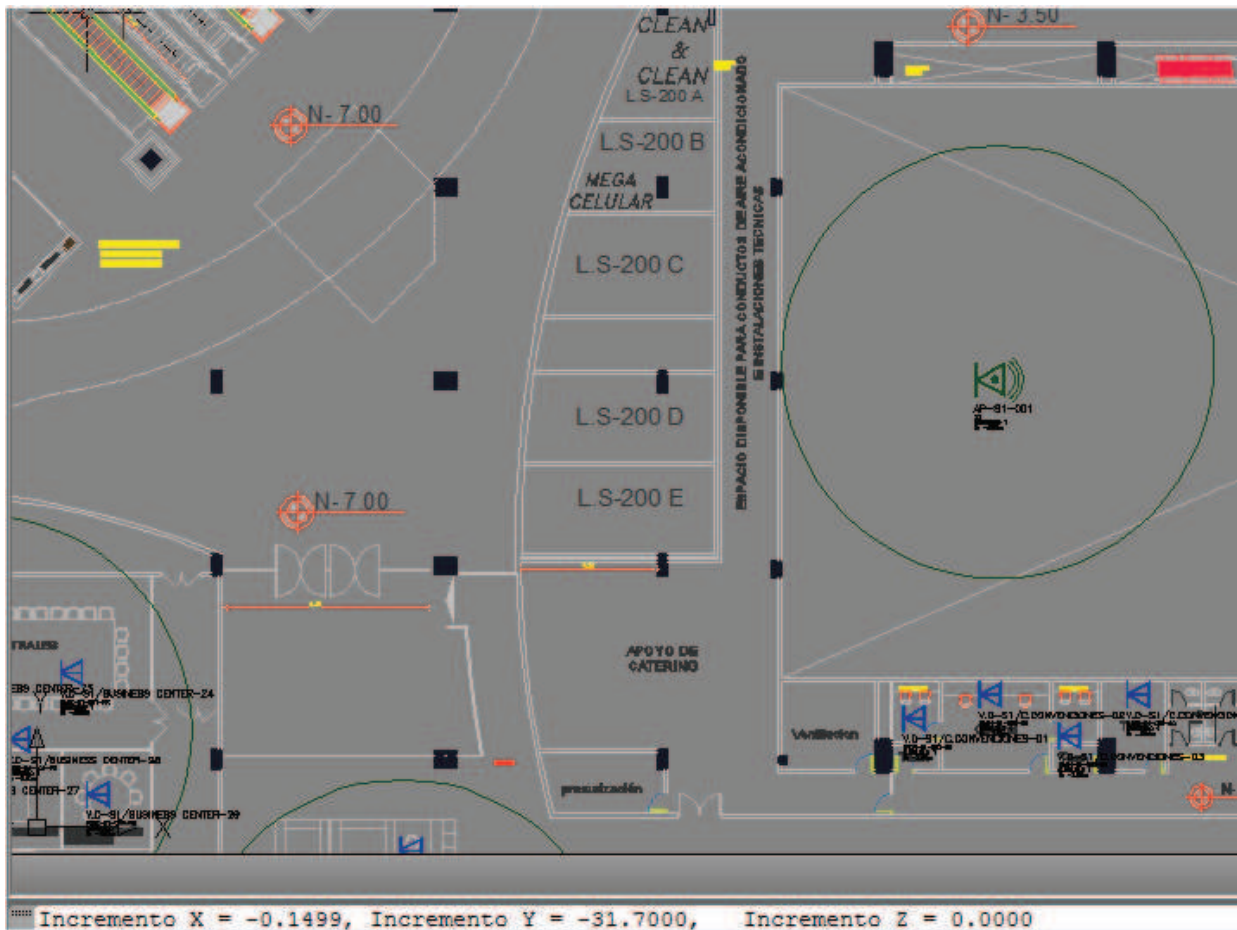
Planta de Referencia para zonas abiertas⁷⁸
